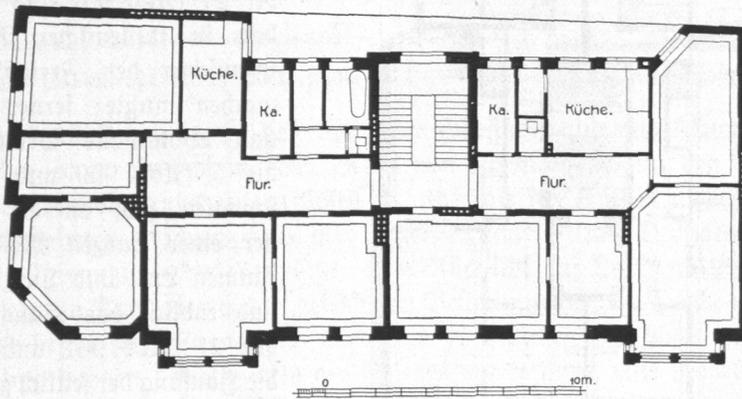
Haus Brandstvierte Nr. 1 bis 5, Obergeschoß.
